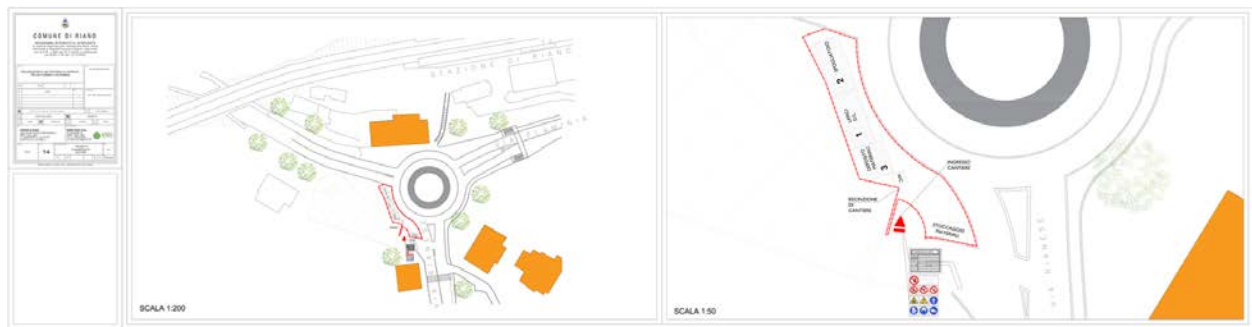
Estratto C14: planimetria di cantiere, accessi, depositi, stoccaggi e servizi.
